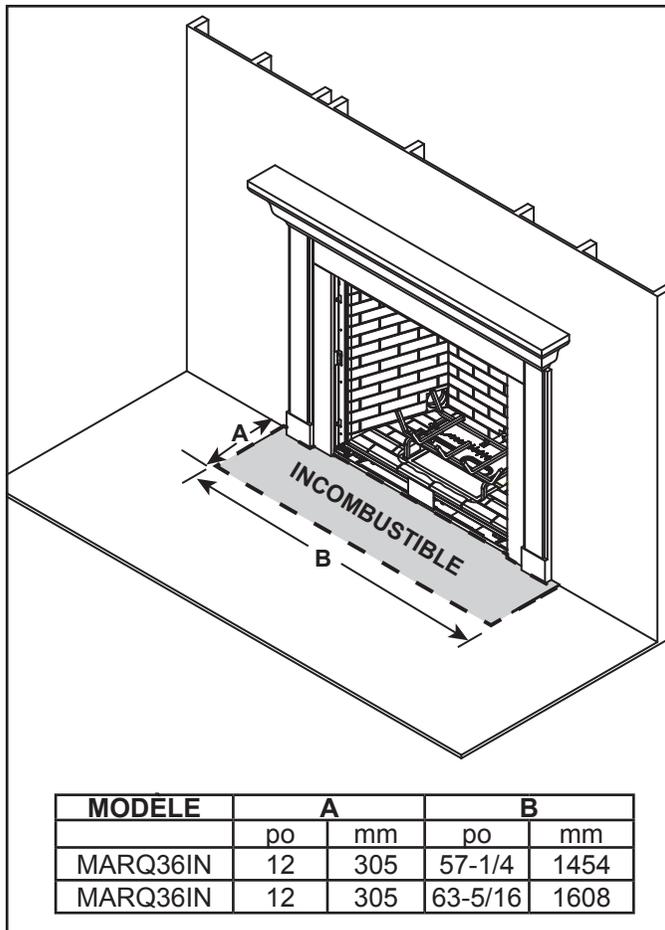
Dimensions du prolongement de l'âtre incombustible
